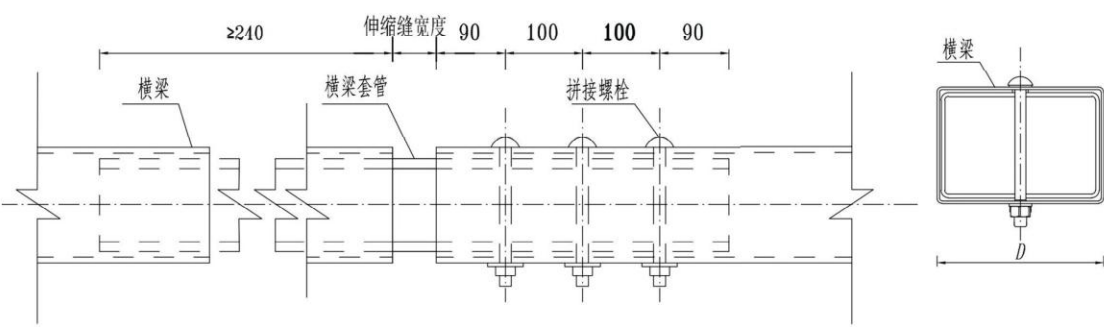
金属梁柱式护栏伸缩缝处构造要求（尺寸单位：mm）
